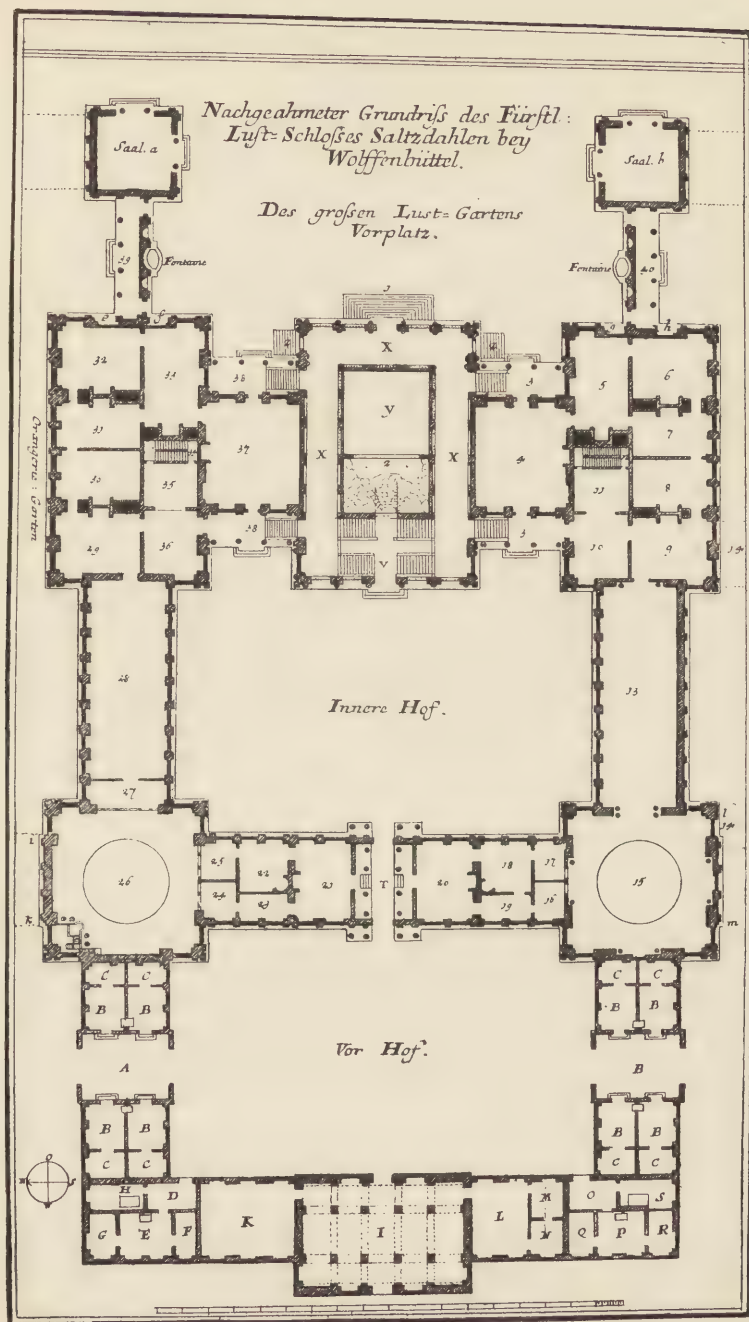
Schloss Salzdahlum. Grundriß, nach I., Sturm.
